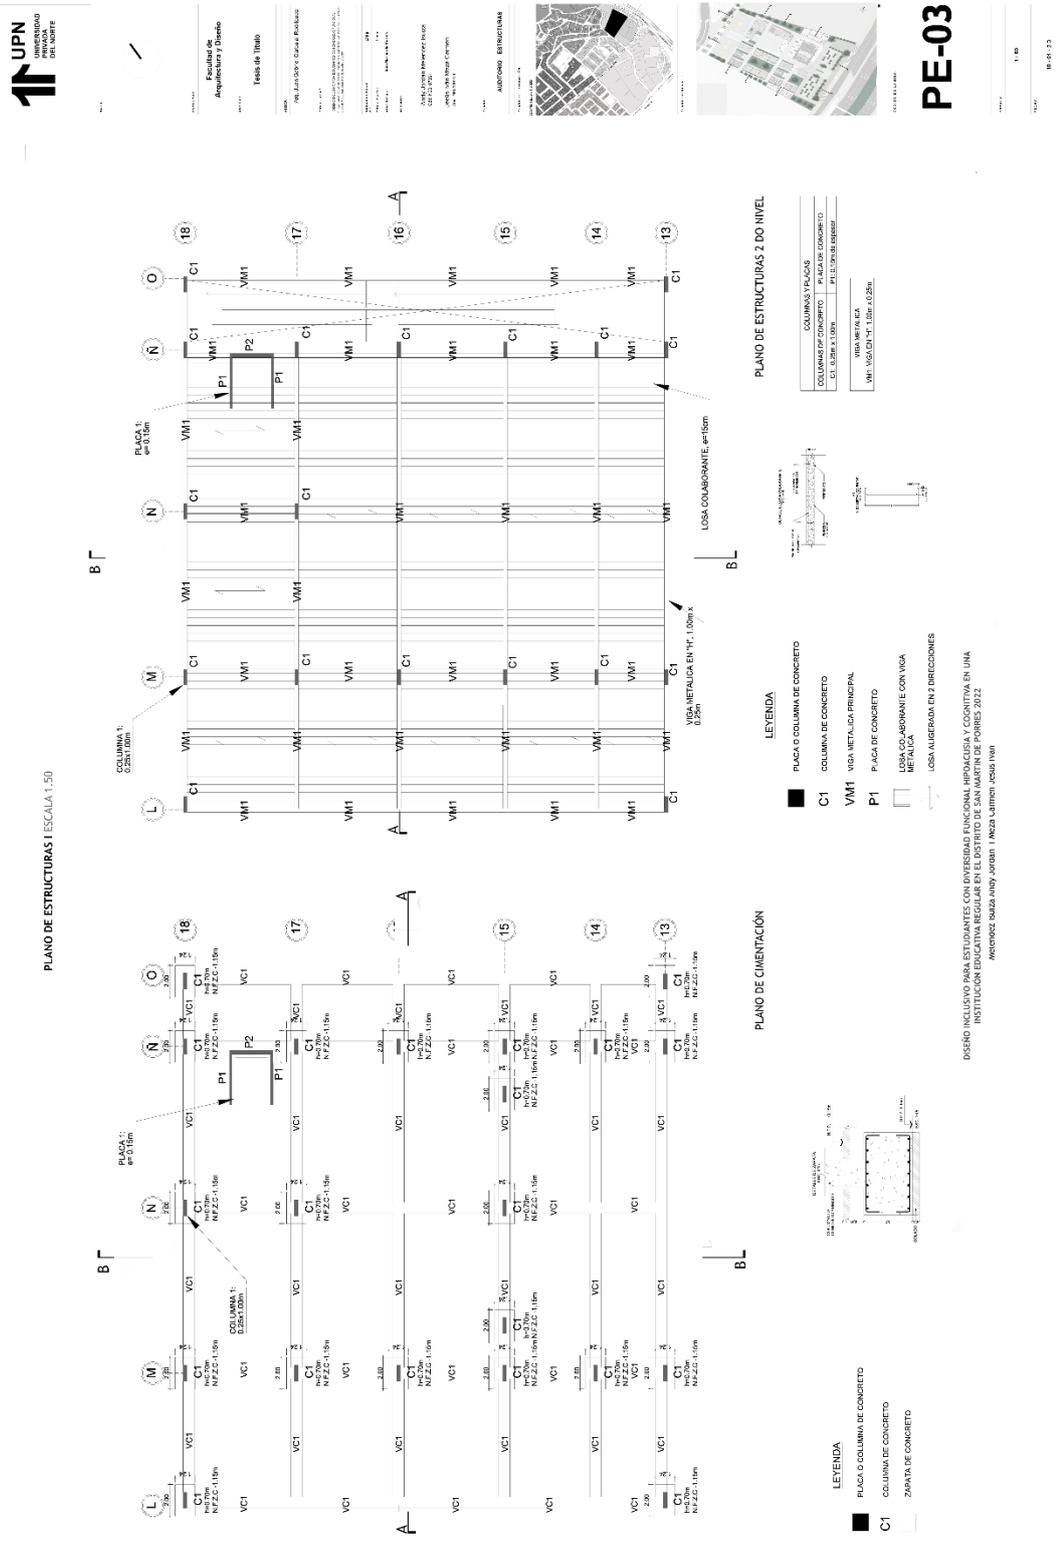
plano de cimentación y losa del cuadrante; fuente: propia
